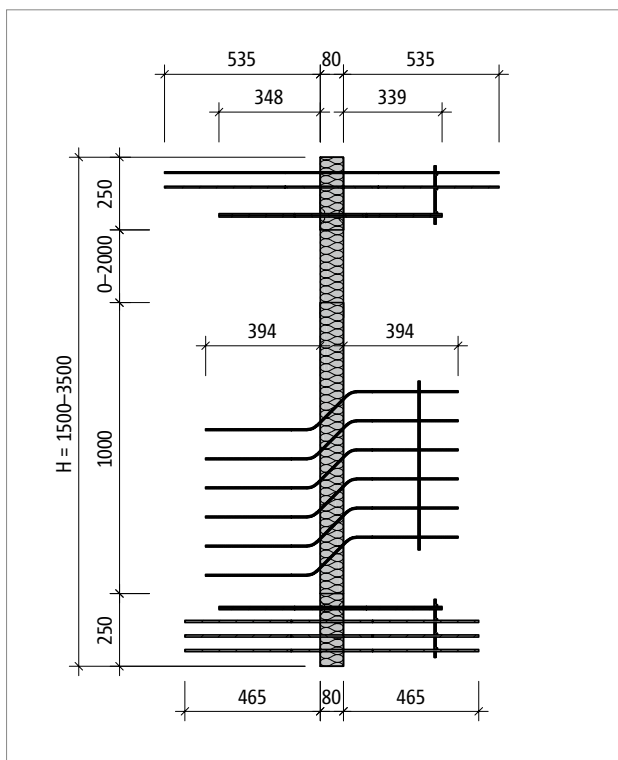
Schöck Isokorf® T type W-M4: Bovenaanzicht
